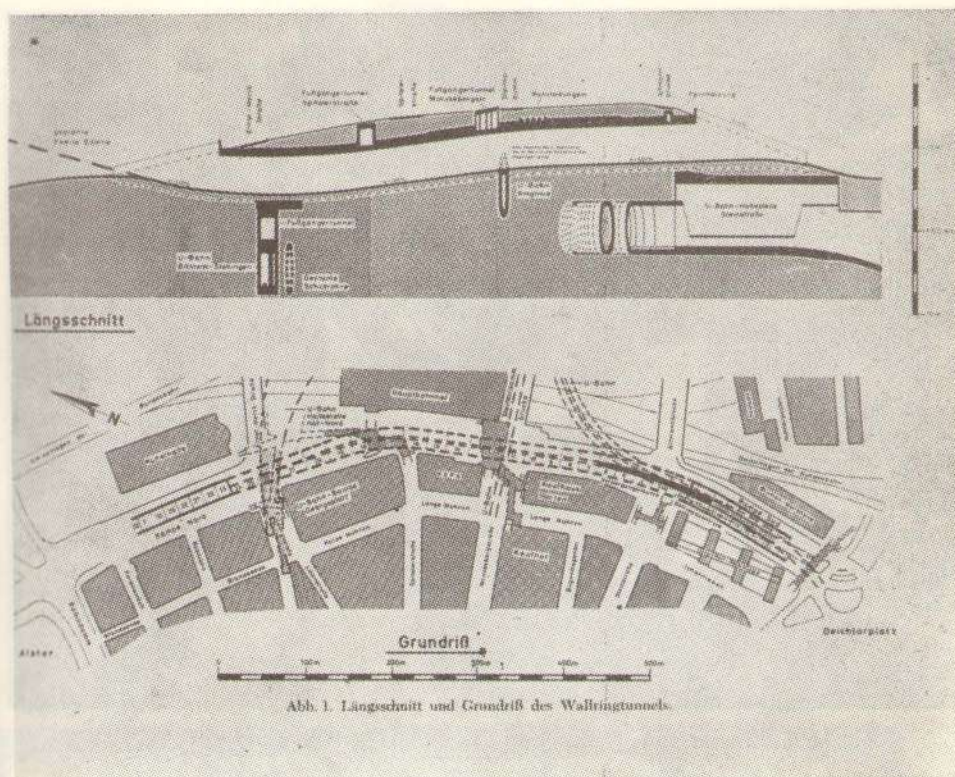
Längsschnitt und Grundriß des Wallringtunnels.
